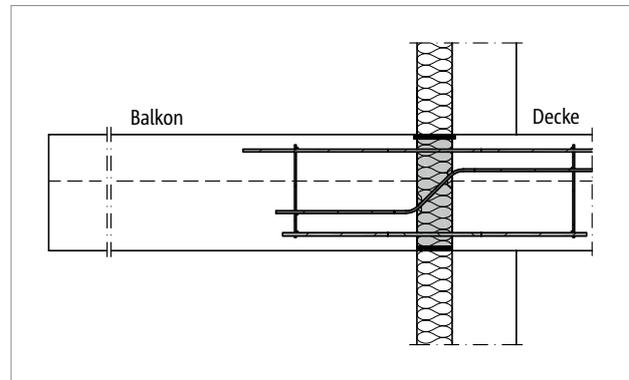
Schöck Isokorb® XT Typ B: Balkonkonstruktion mit frei auskragenden Unterzügen
